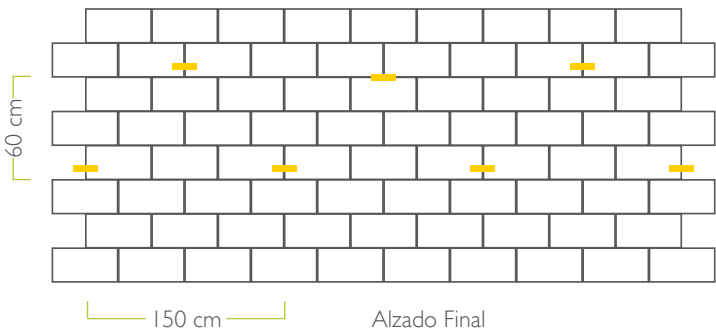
Detalle de anclajes de Biomattone contra muros existentes
